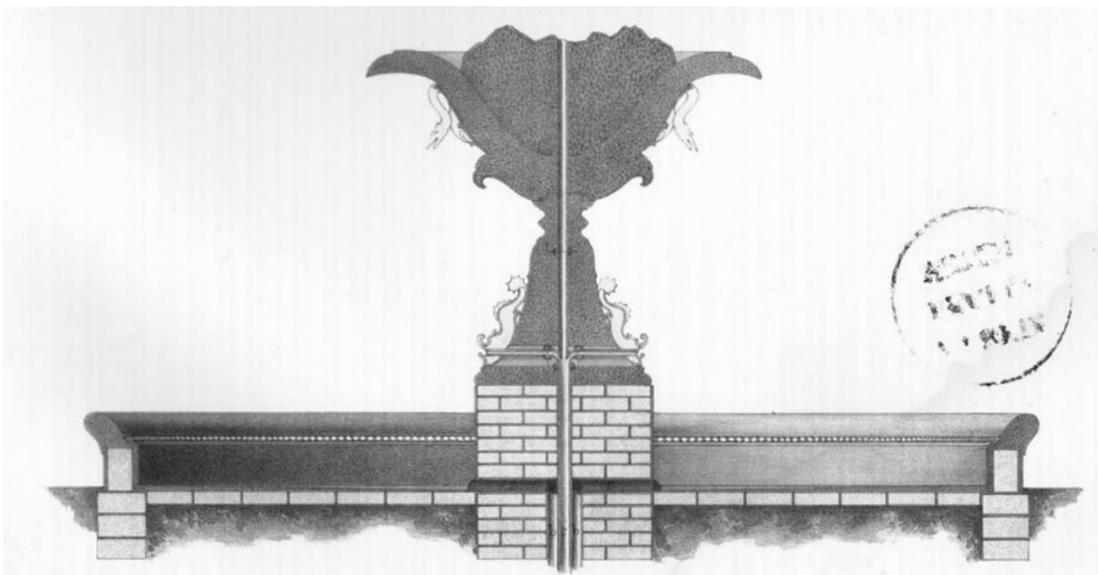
Schnitt einer Brunnenanlage mit vor Ort gemauertem Becken und Fertigteilvase, nach Becker 1868
